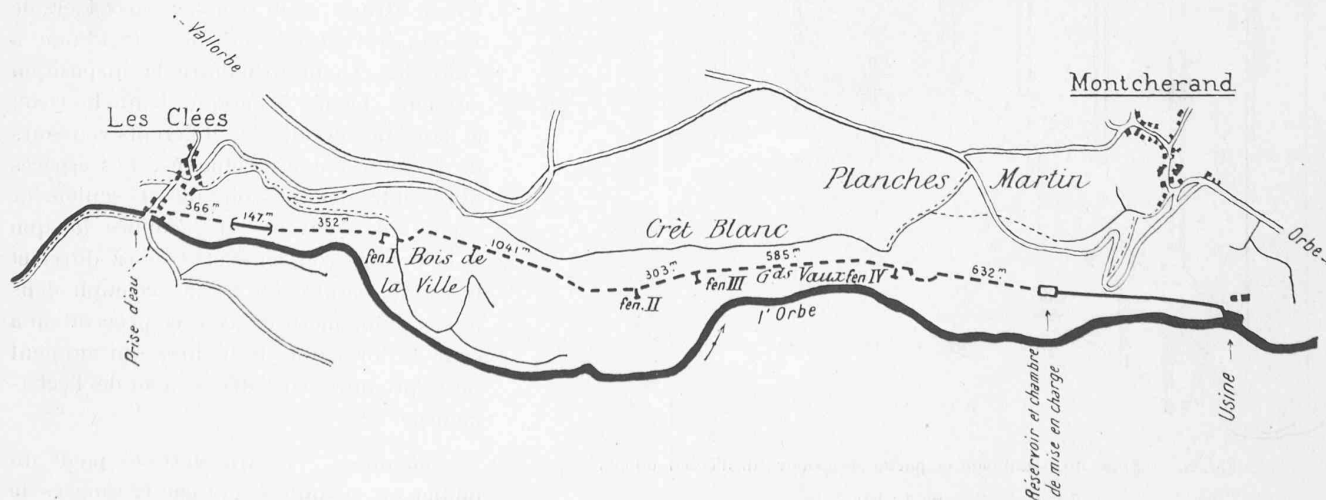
Plan de situation du canal de dérivation. — Echelle 1 : 25000.
